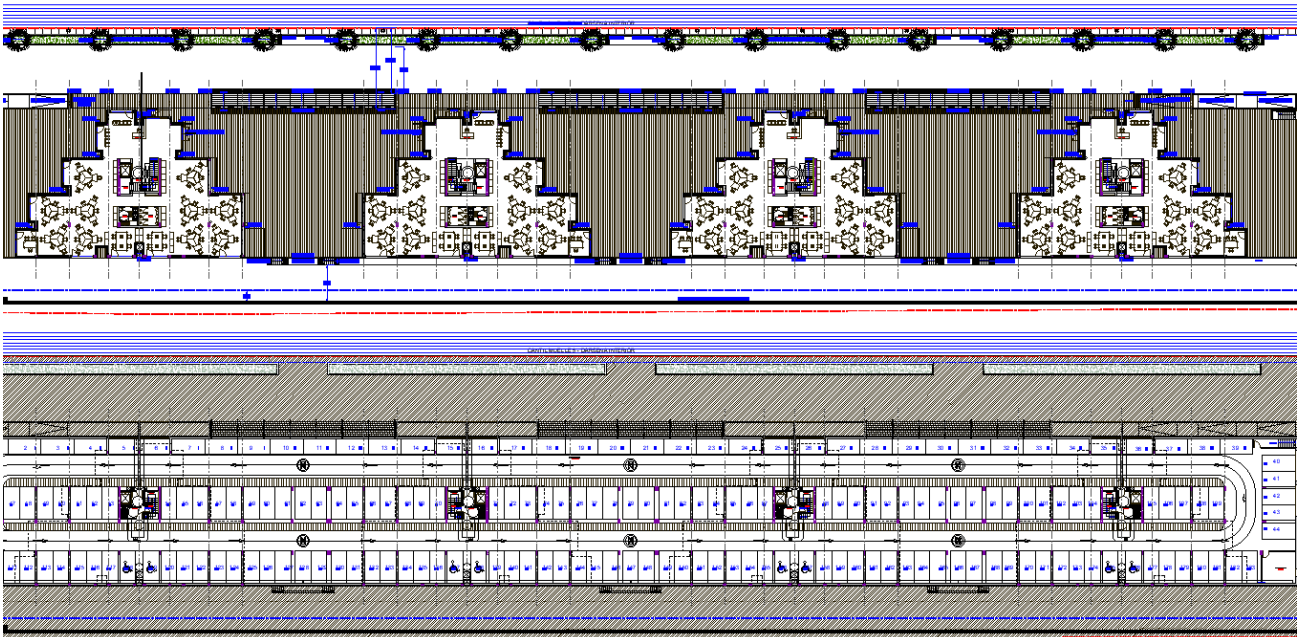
Plantas de uso del edificio, a. planta 1ª b. planta -1ª respectivamente
